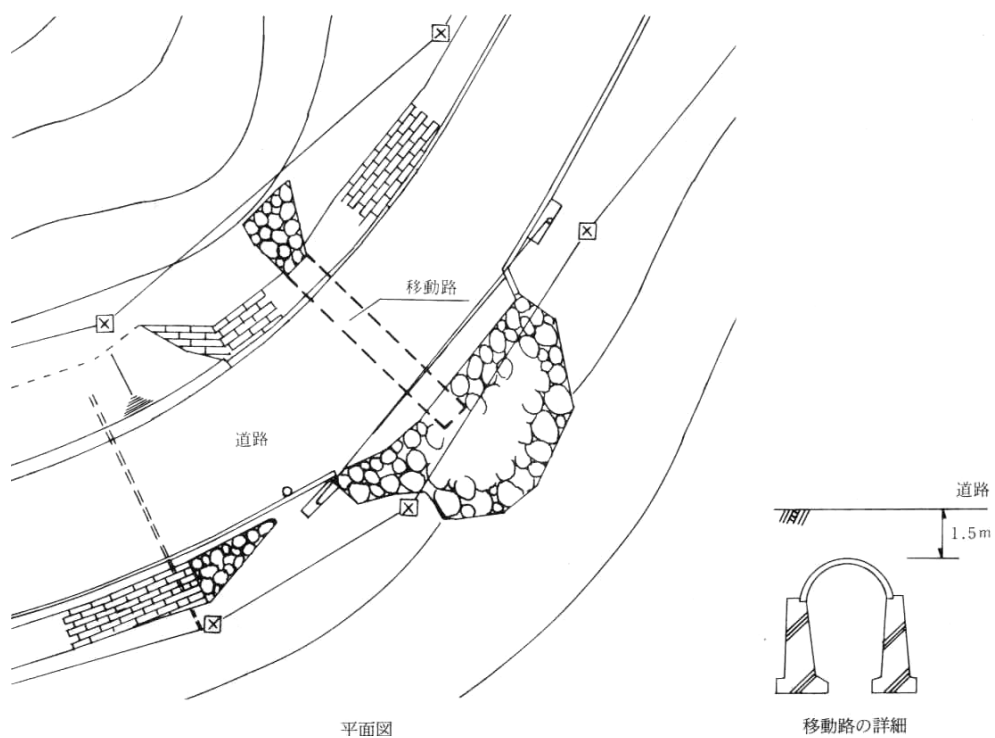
移動路の平面図 (左) 及び断面図 (右下)
